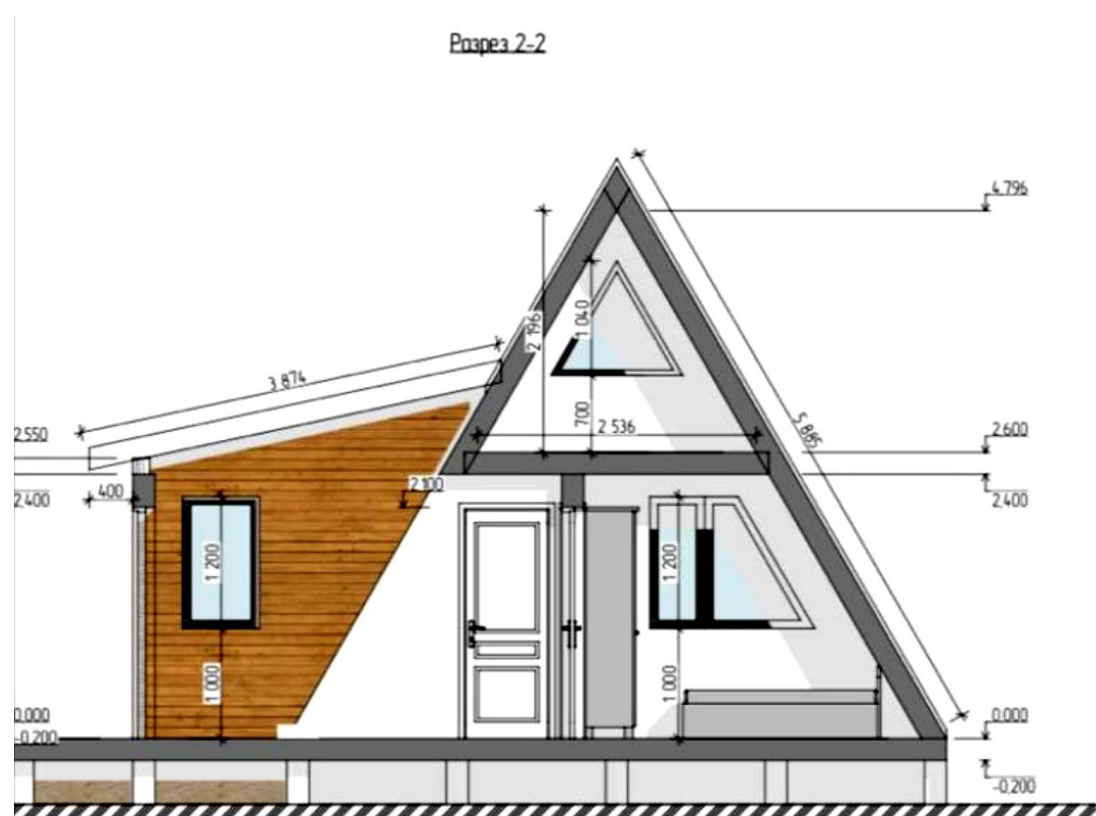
Габаритне креслення планування каркасної будівлі.
